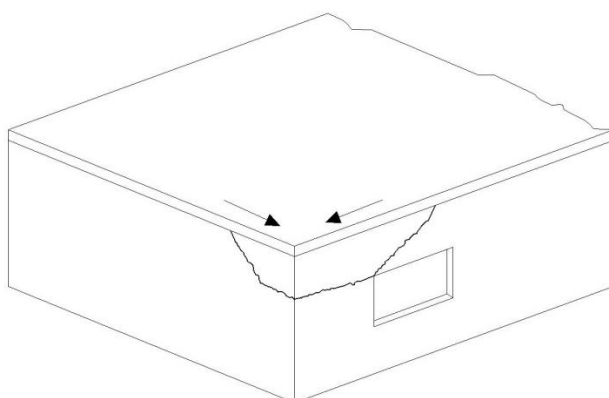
Trincas inclinadas em encontros de vigas
